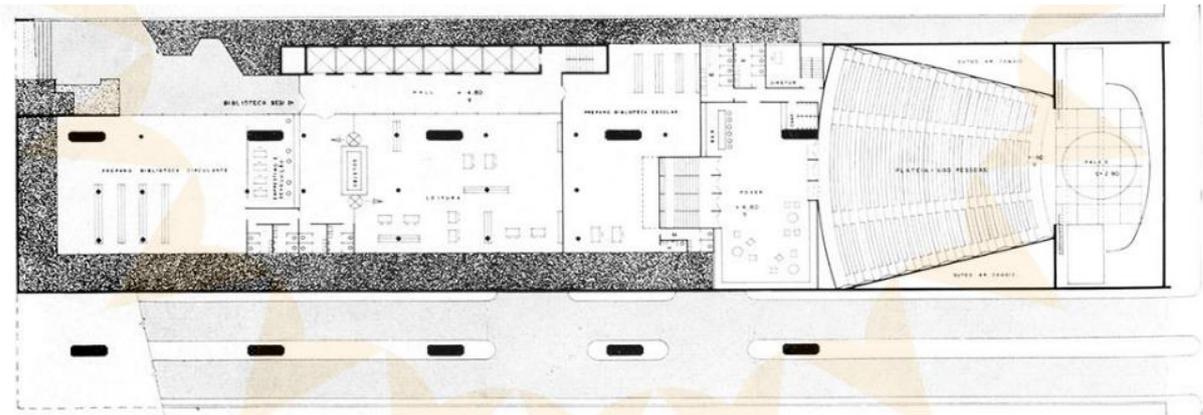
Pavimento térreo inferior – área de atividades culturais e rua interna apenas para automóveis
